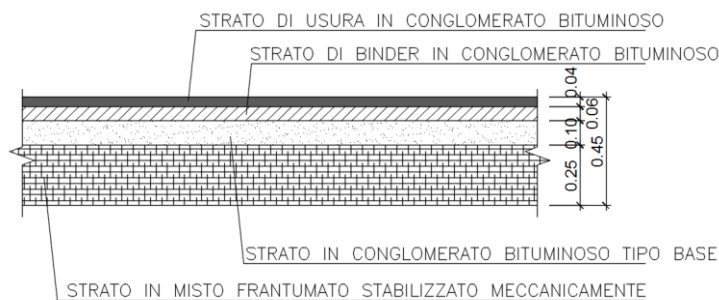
Pacchetto pavimentazione Strada F - Locale in Ambito Urbano
